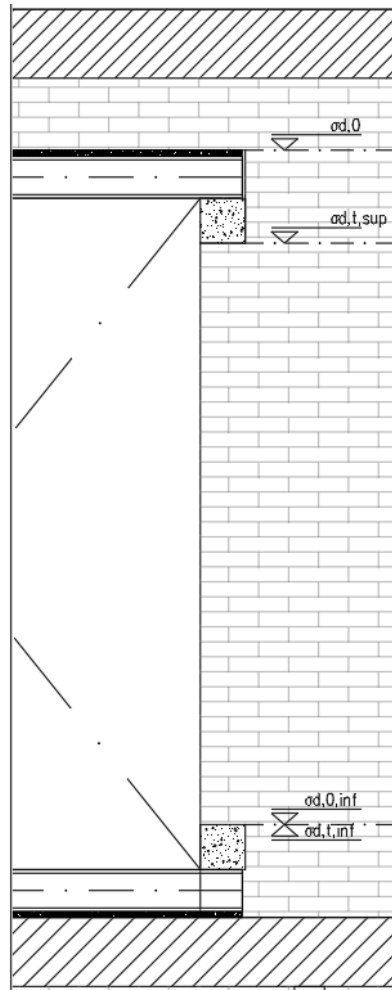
Localización de esfuerzos entre apoyos de vigas. Fuente: elaboración propia
